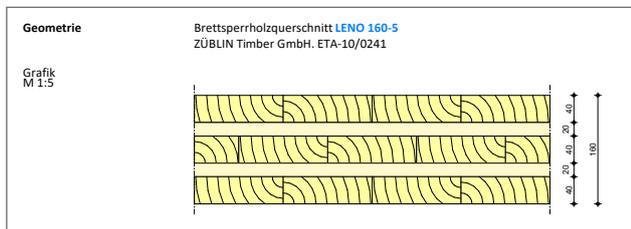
Querschnitt eines Bauteils mit Brettsperrholz
